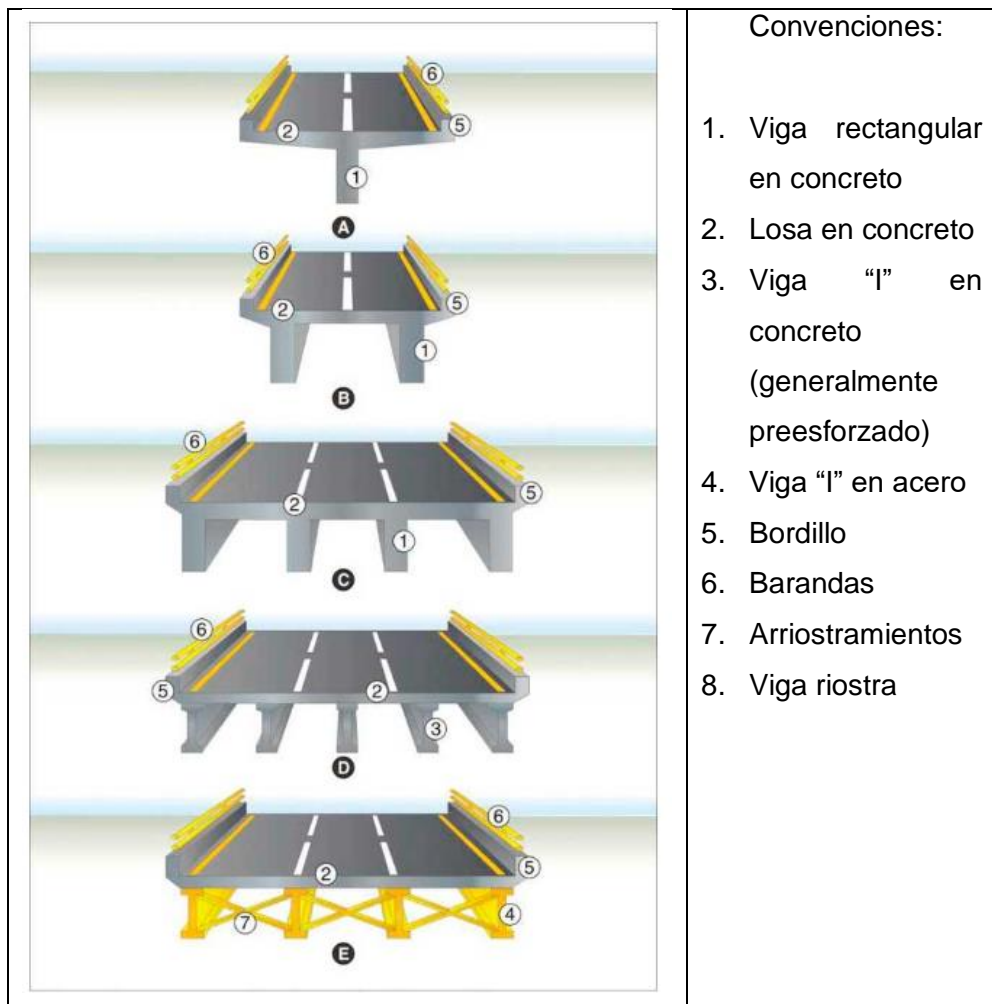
Tipología de sistema de entrepiso vigas y losa. (A) Una viga. (B) Dos vigas rectangulares. (C) Cuatro vigas rectangulares. (D) Cinco vigas "I" preesforzadas. (E) Cuatro vigas armadas de acero con arriostramiento
